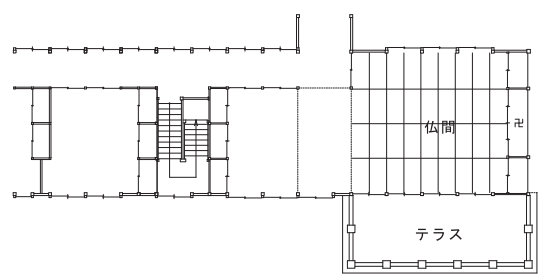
宿舎棟一号楼 2 階寮室および広間復元平面図 1/400
